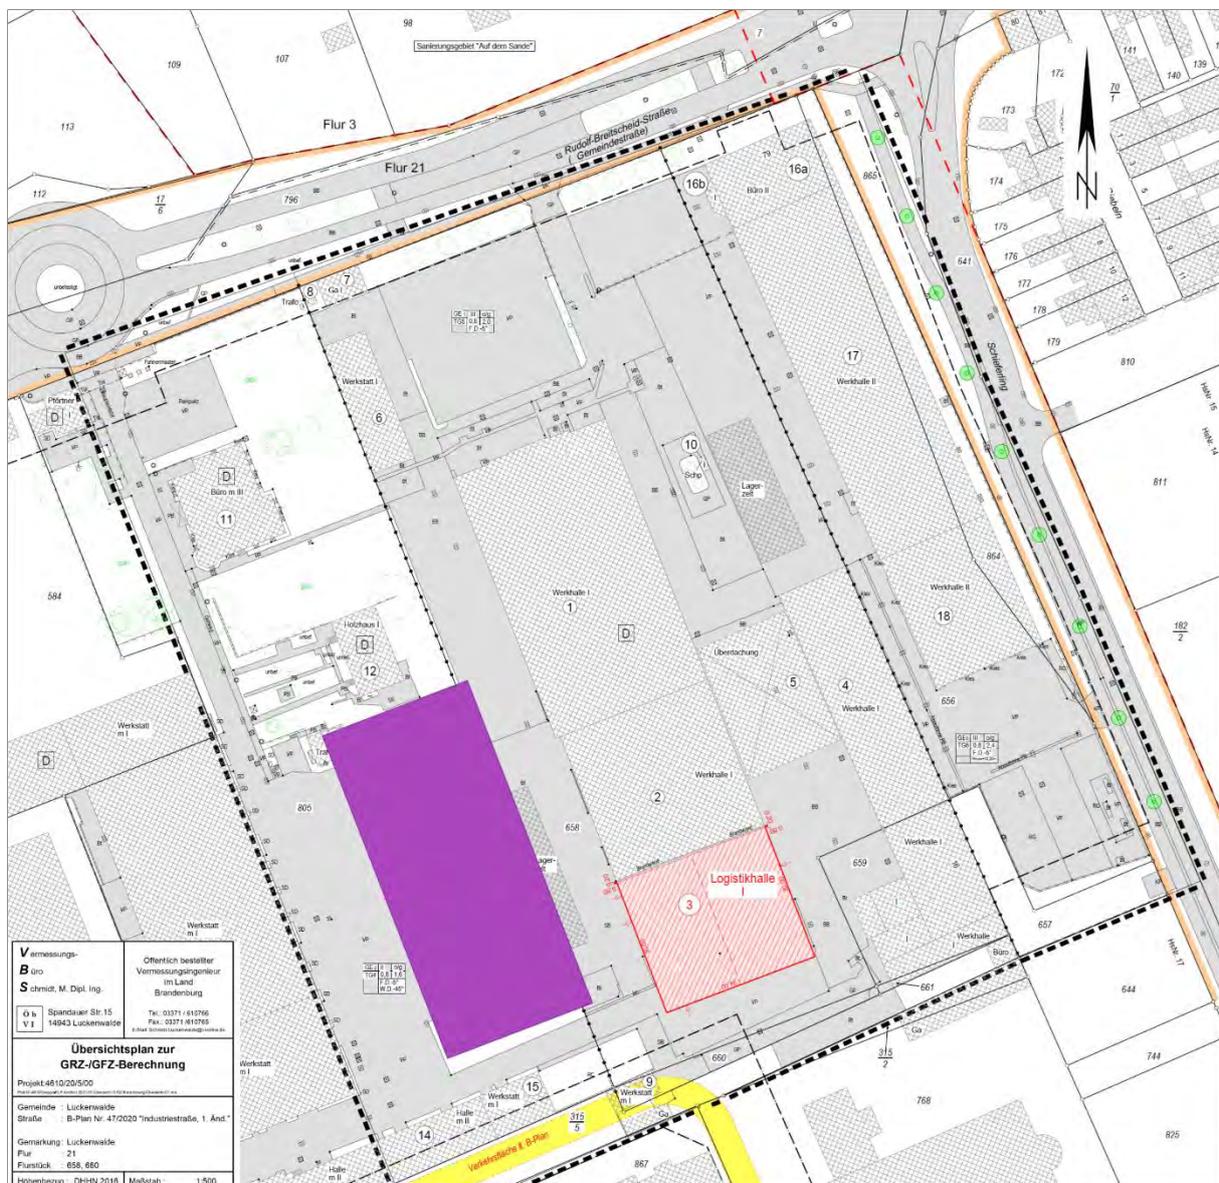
Lageplan der Vorhaben (Logistikhalle in Rot, Produktionshalle in Lila)
